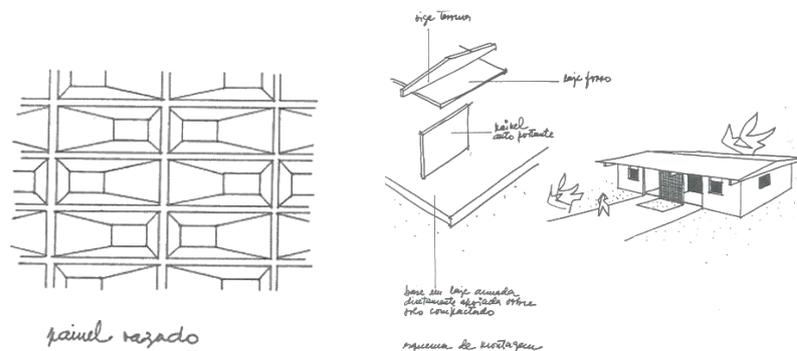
Croqui, Casa 05. Detalhes construtivos.
